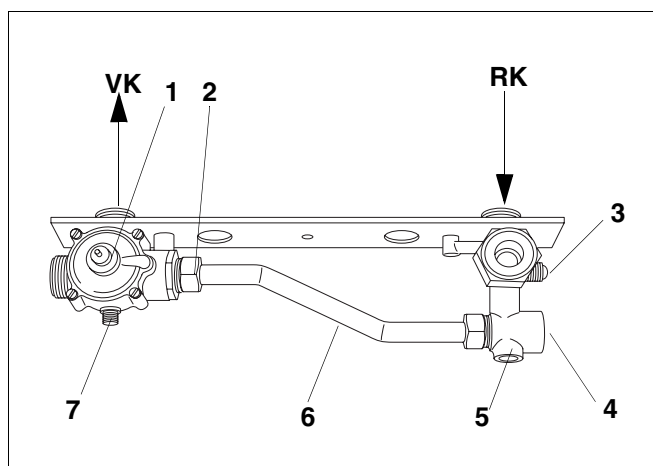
Hydraulická jednotka kombinovaného přístroje
